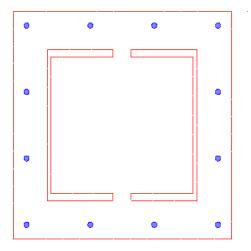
Сечение с жесткой арматурой, образованной из швеллеров
